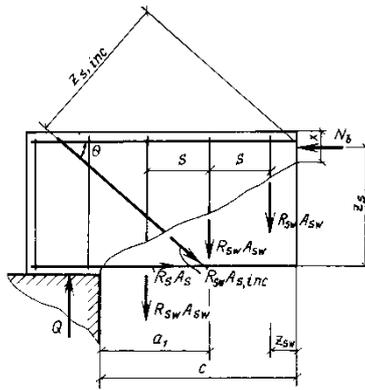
К расчету ригеля по изгибающему моменту.
